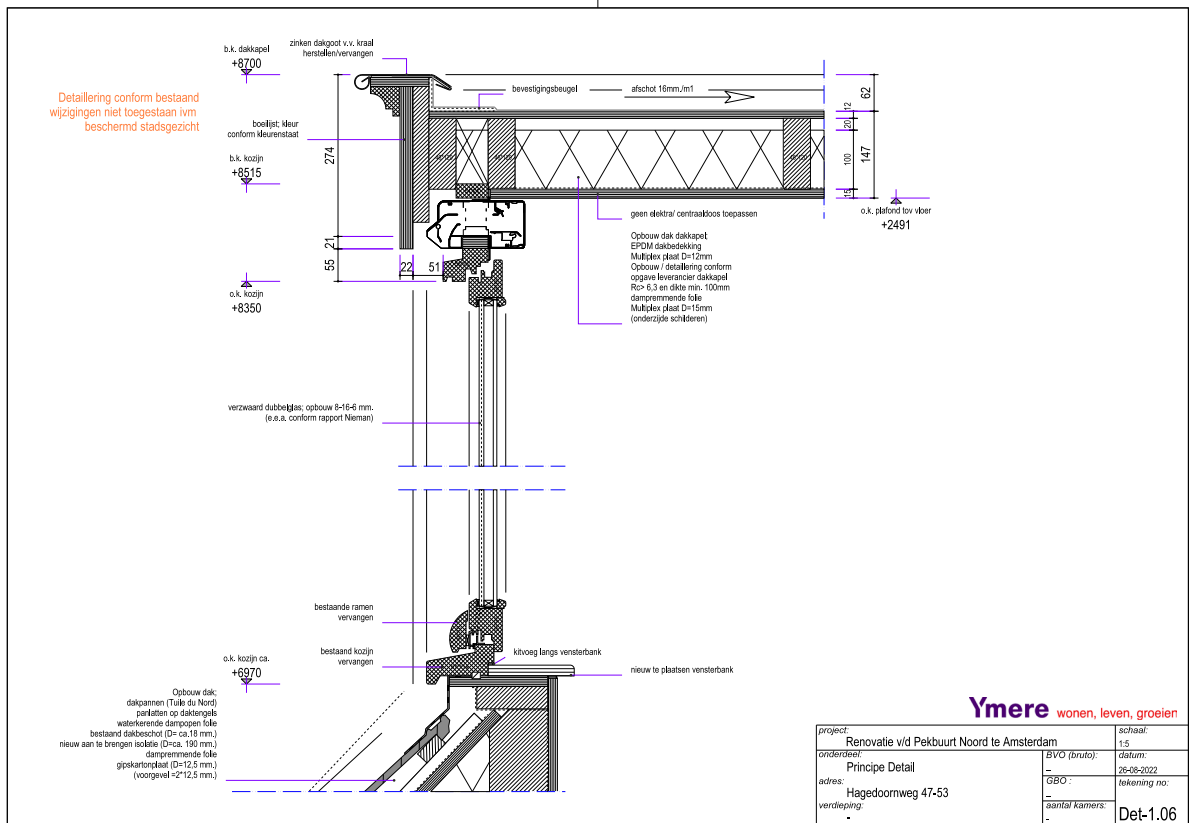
A.6 Detail Ventilatie ramen dakkapel voorgevel
